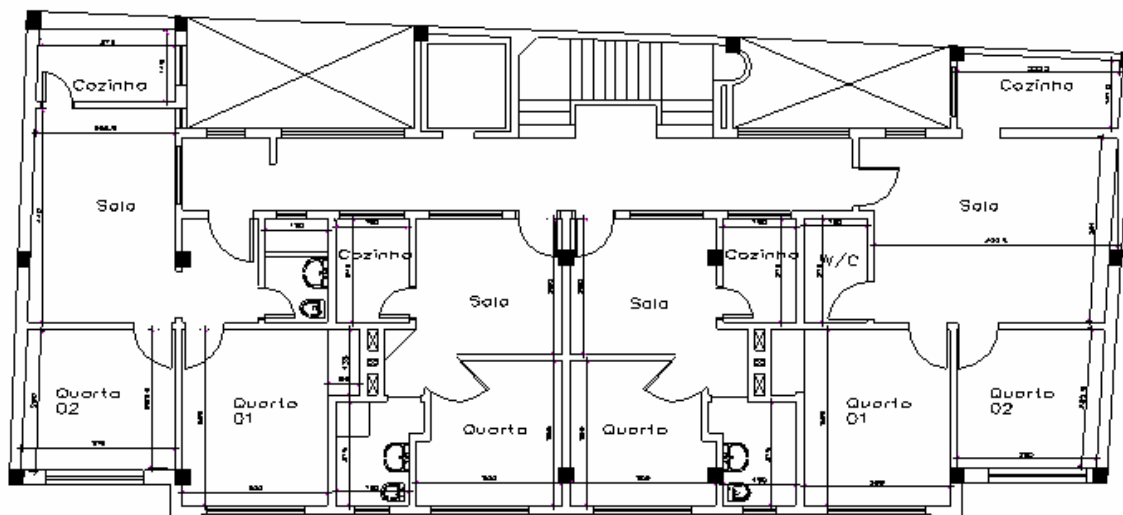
Planta baixa arquitetônica do pavimento tipo do edifício, referente ao primeiro projeto realizado, contemplando 24 unidades residenciais.
